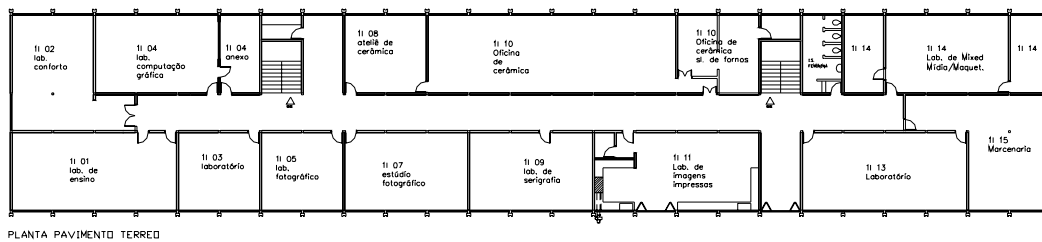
Planta Baixa do primeiro pavimento do Bloco I
